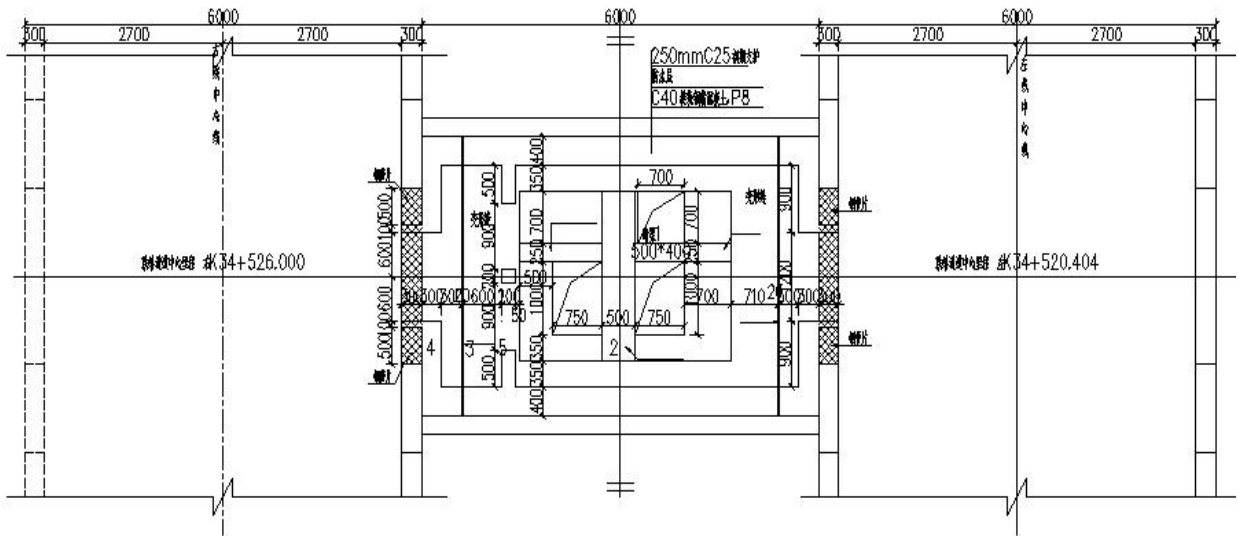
天-永区间 2#联络通道及泵房结构平面图
